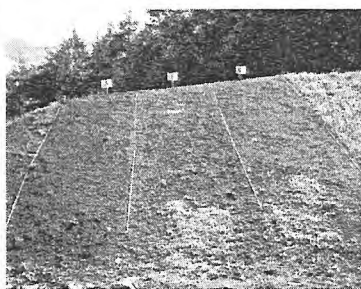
施工48日後 写真-7 施工80日後 写真-8 施工1年後
